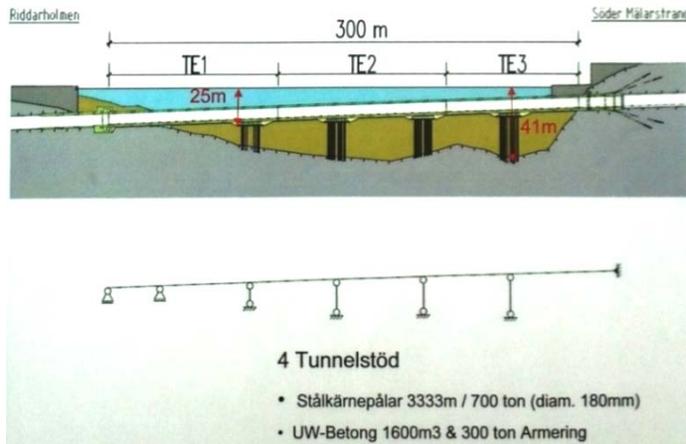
Tunnelsegmente und statisches System<sup>3</sup>
